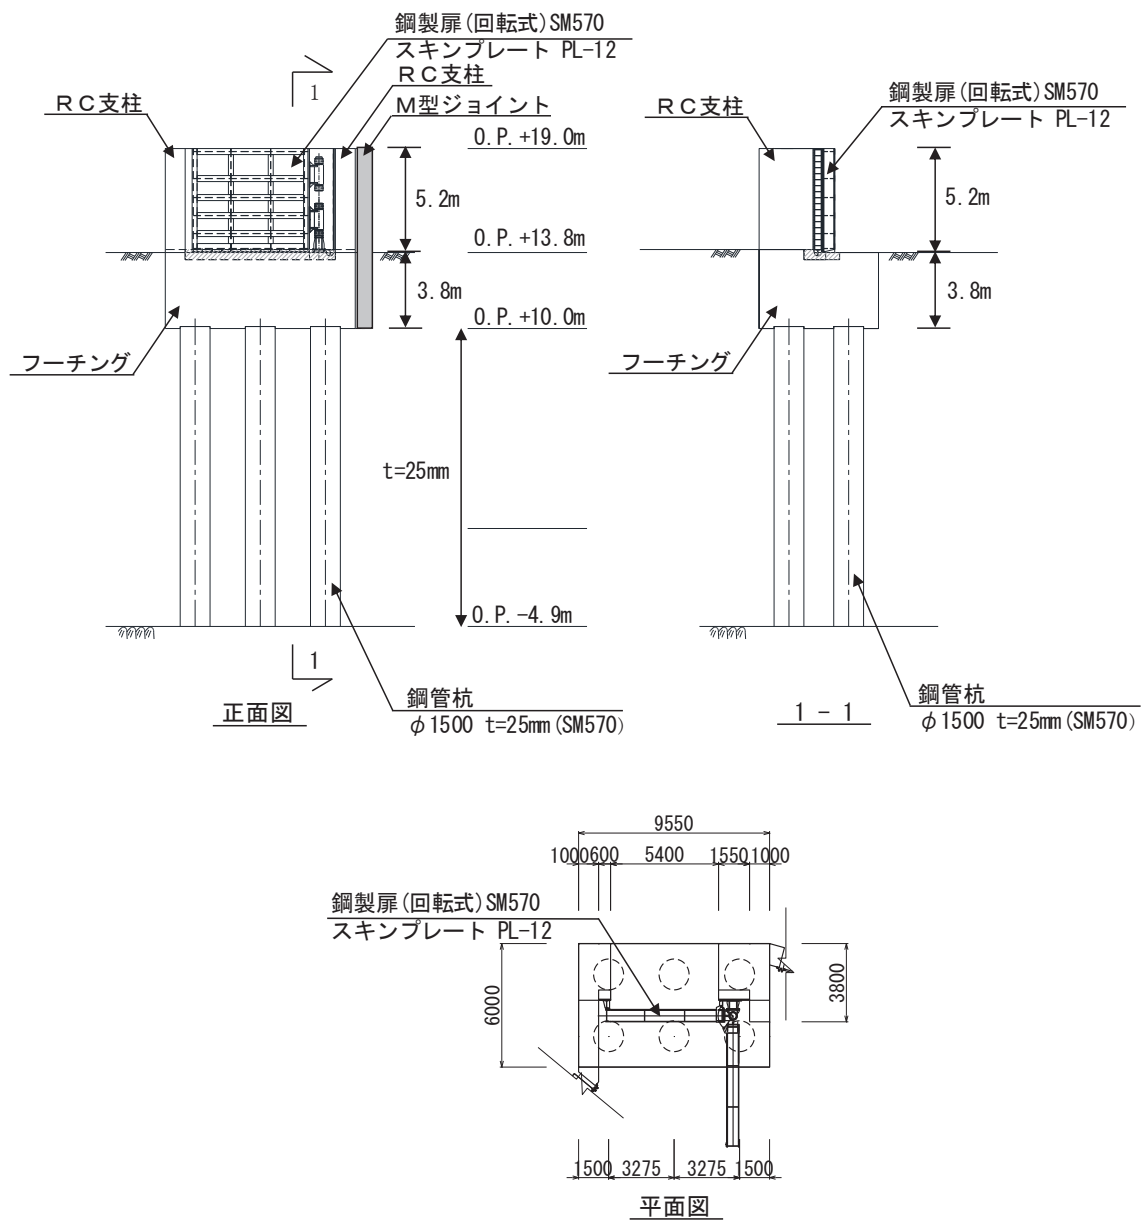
鋼製扉 2 の構造図 (正面図及び断面図, 平面図)
